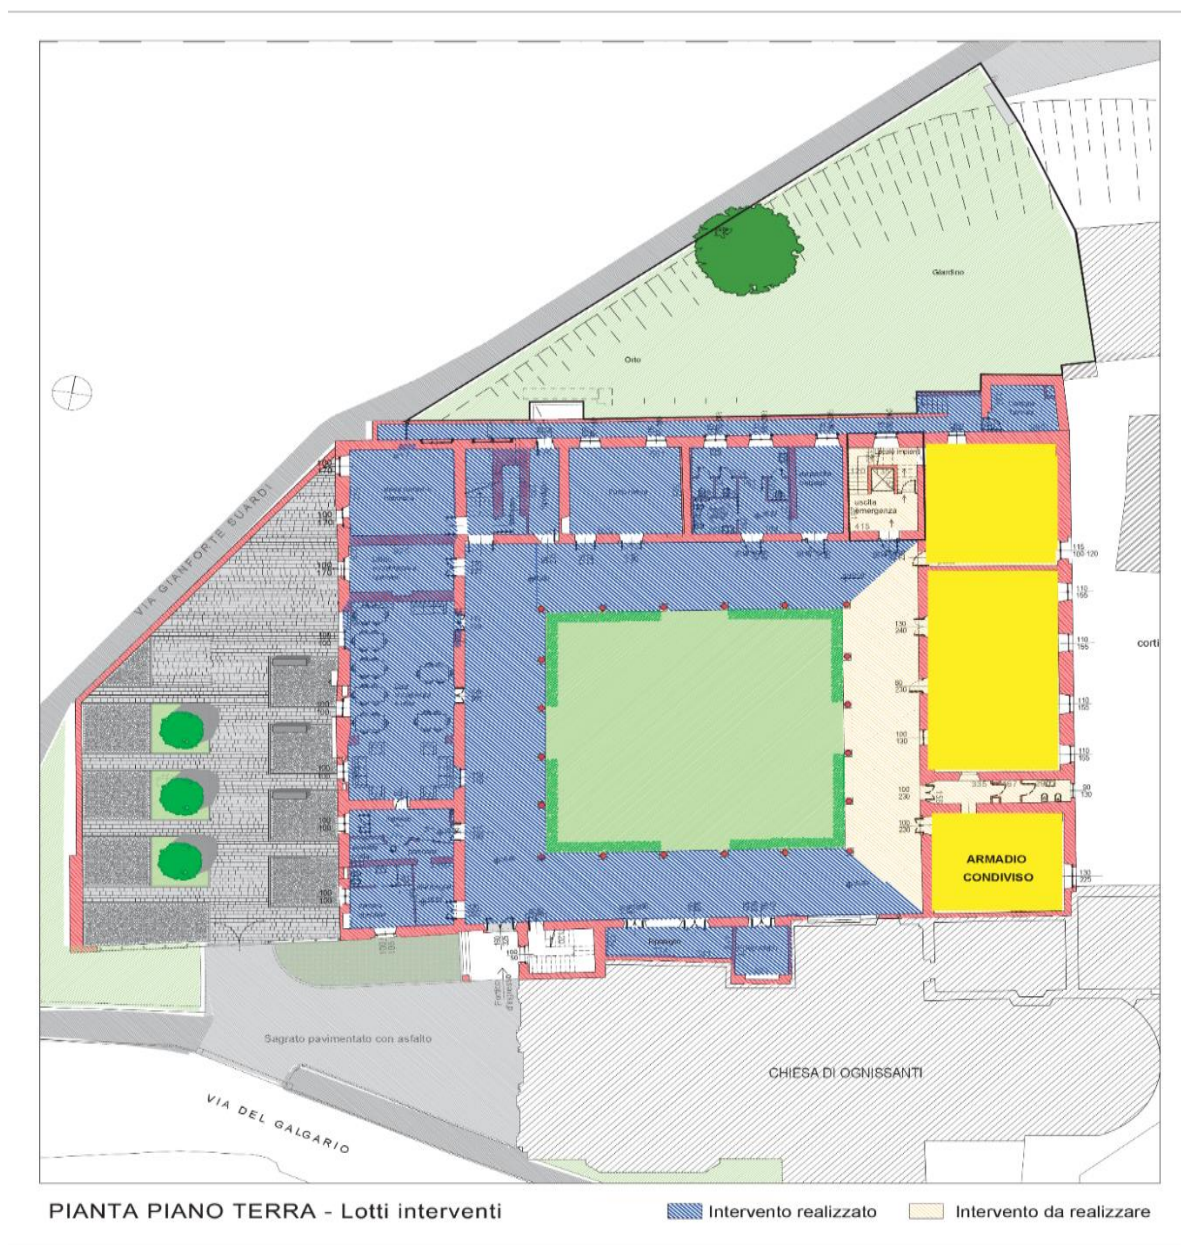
Pianta del piano terra con, in giallo, la parte del lotto da ristrutturare
